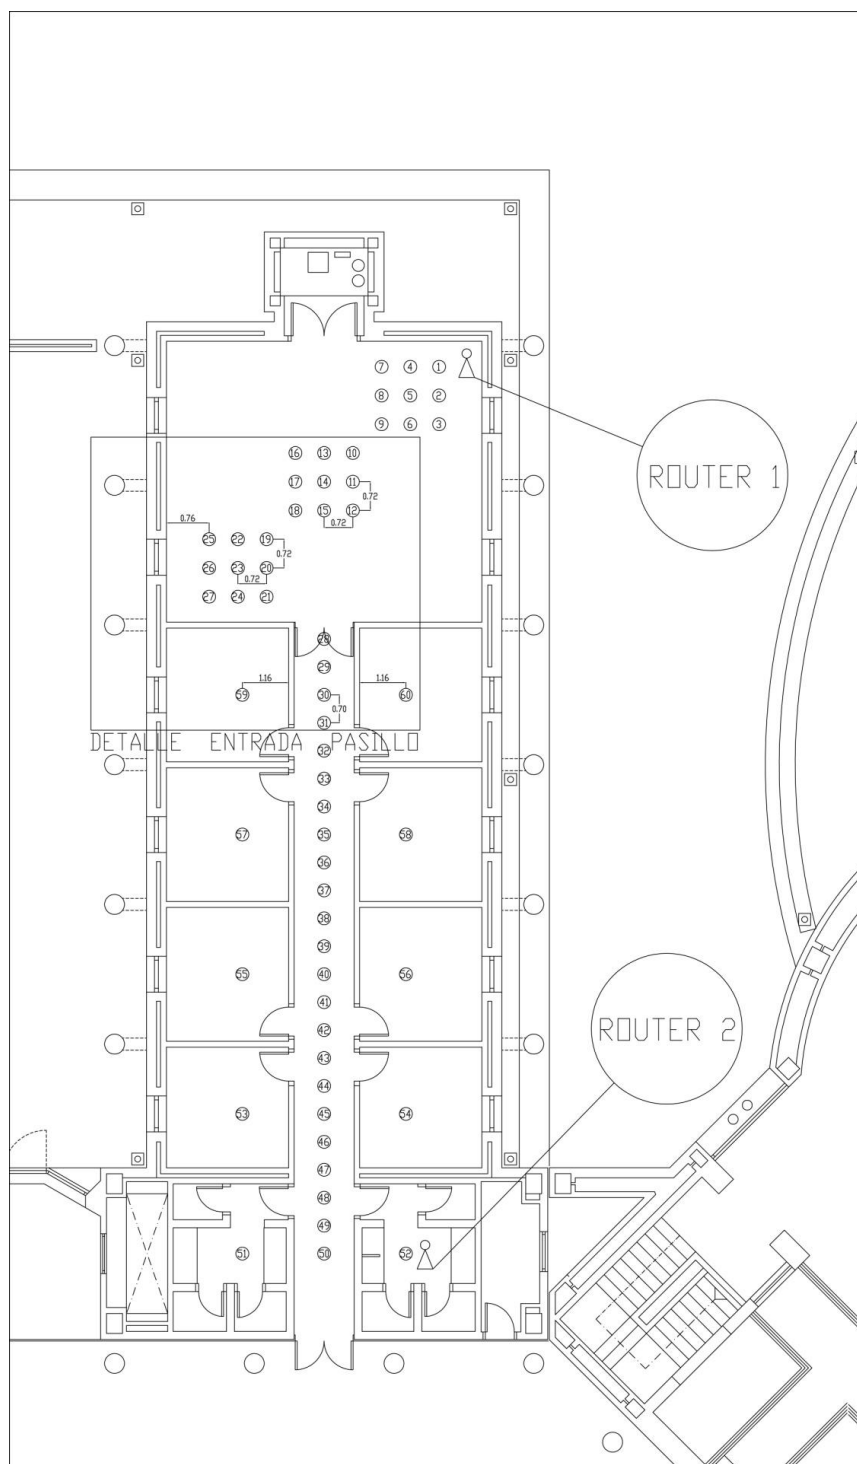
Pasillo de despachos Zona Norte, primera planta del edificio Politécnico de la Universidad de Alcalá.
